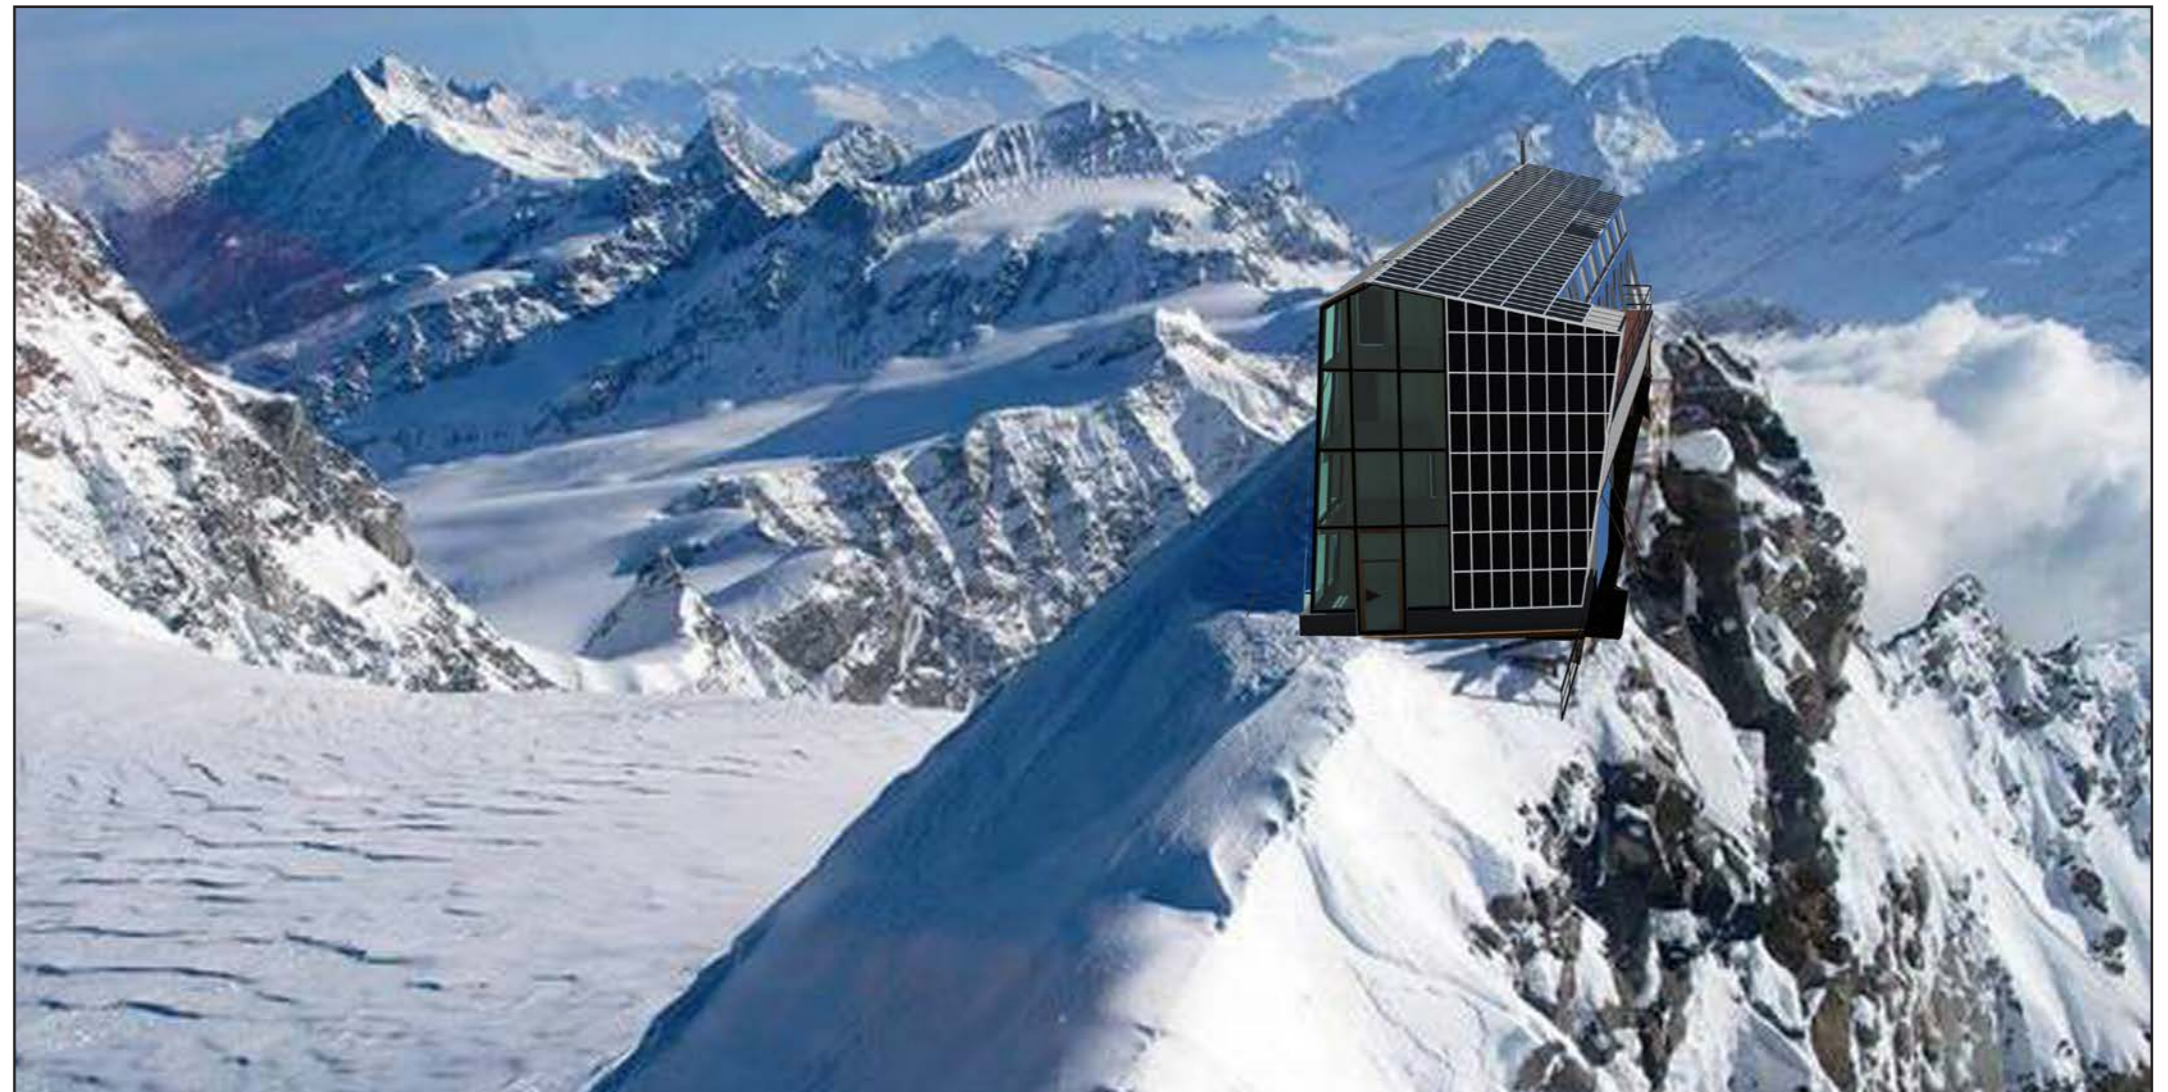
Render di progetto vista sud-est zona ingresso.
